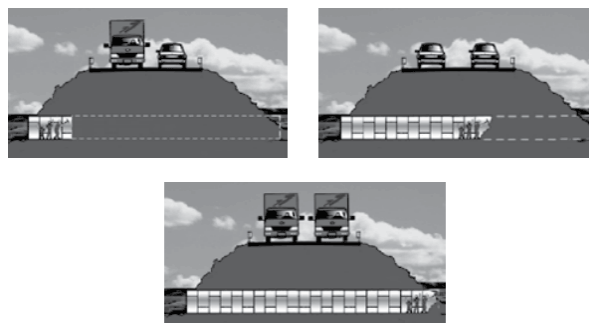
Implantação de Tunnel Liner. Fonte: Armco Staco (2013).
